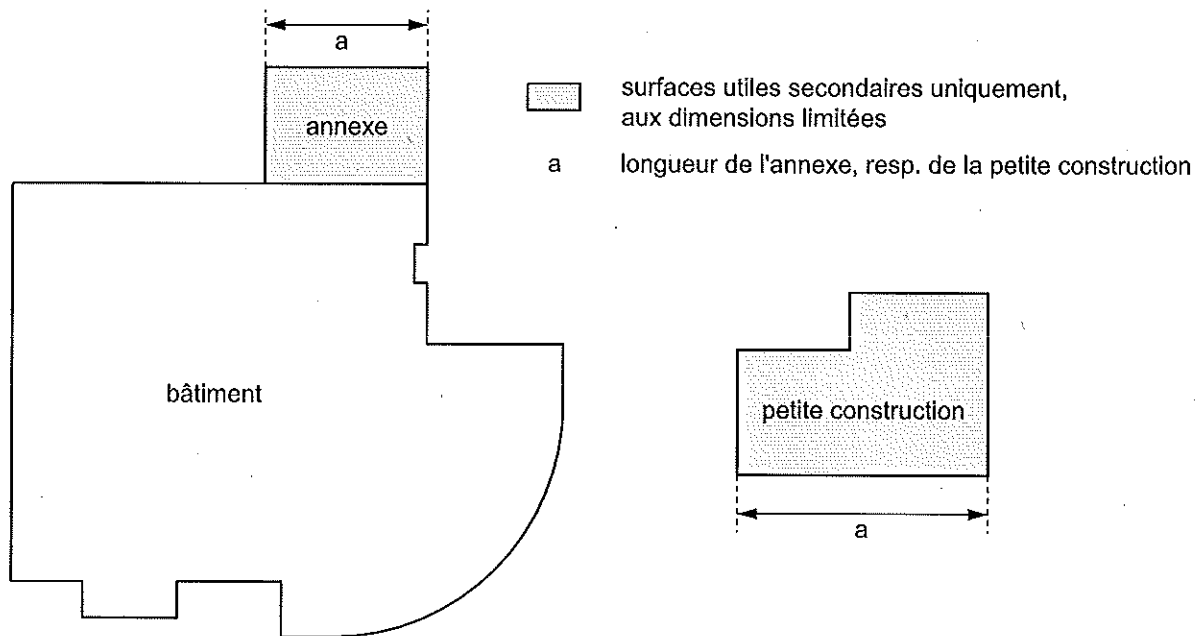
2.3 Bâtiments, petites constructions et annexes
